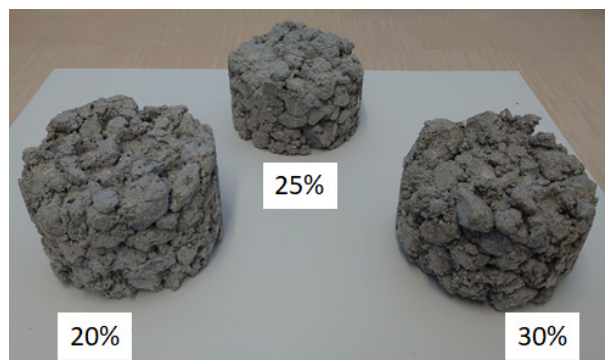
緑化コンクリートの供試体（数字は全空隙率）
